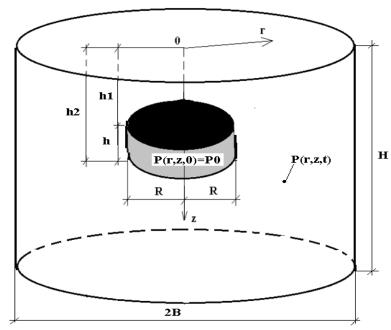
К определению порового давления в грунтовом основании при устройстве грунтоцементного элемента
